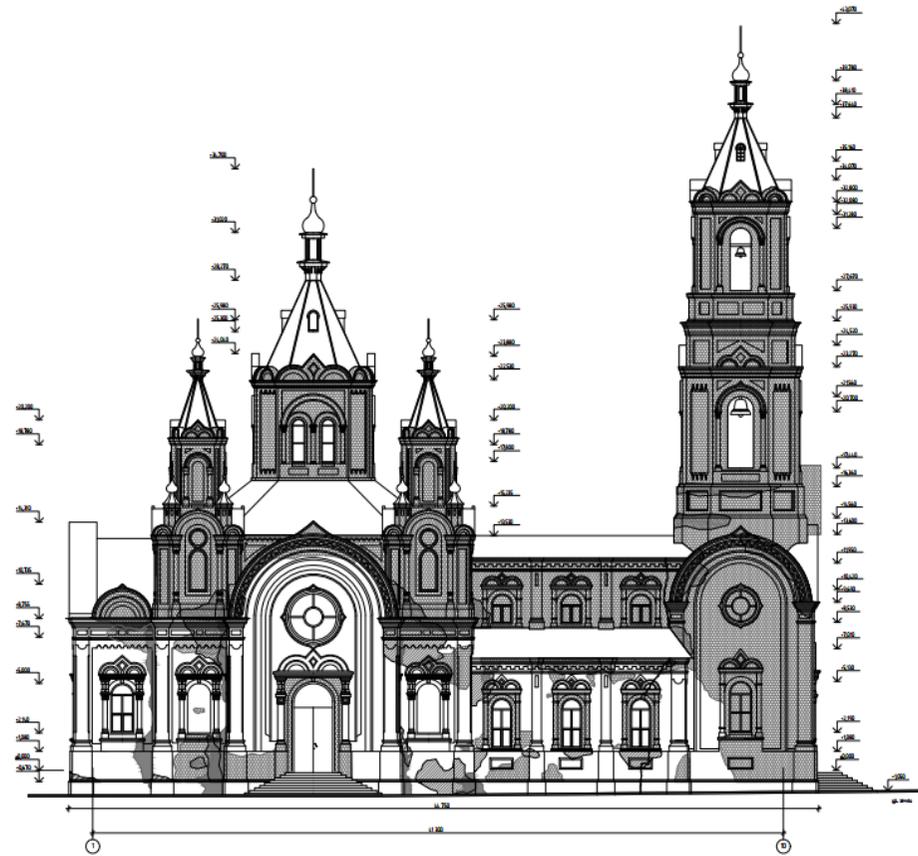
фасады А-П, 1-10 до реконструкции
